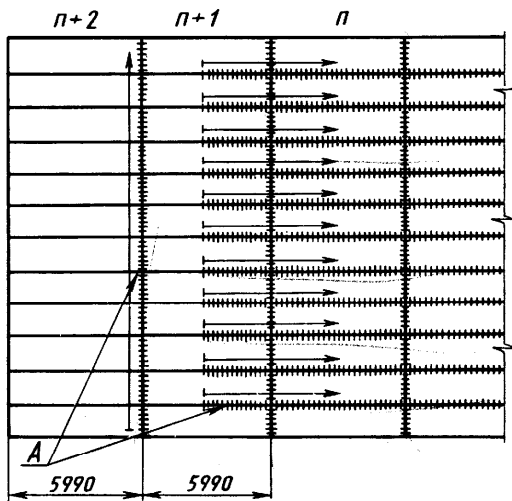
Последовательность сварки полотнища стенки резервуара объемом 50000 м³
